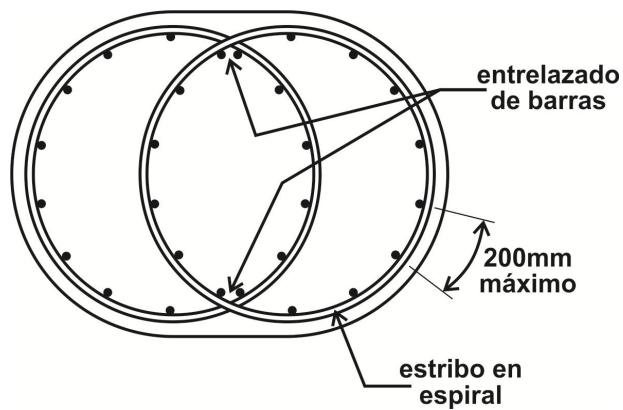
3: Detalles de Entrelazado de Estribos en Columnas
